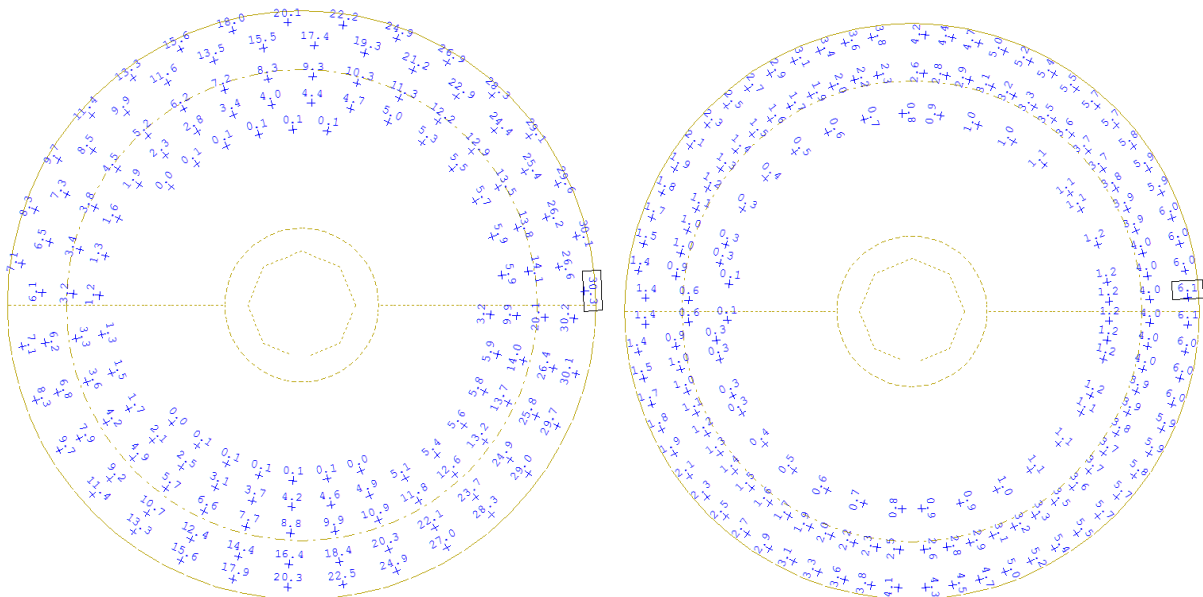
Bewehrung auf der Außenseite des Deckels (Draufsicht auf das Betonbucket; Extremlastfall 1 – Leeseitig, Fußpunkte eingespannt)
